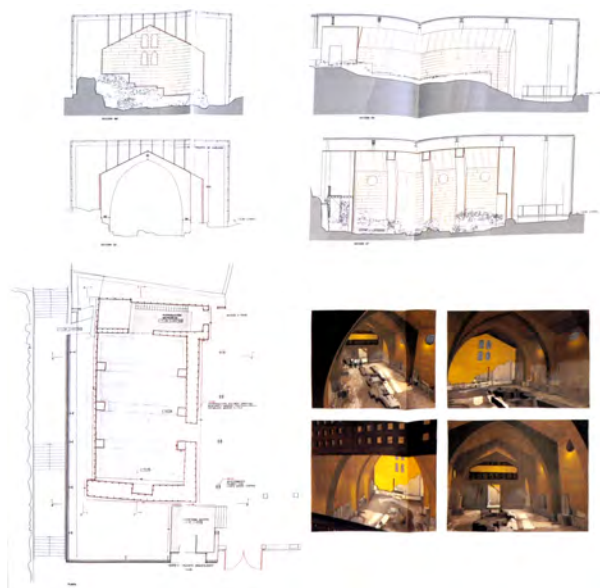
Plano con vista de sección, alzado, plantas e infografías de adecuación de la sinagoga. (Jurado, 2009)
